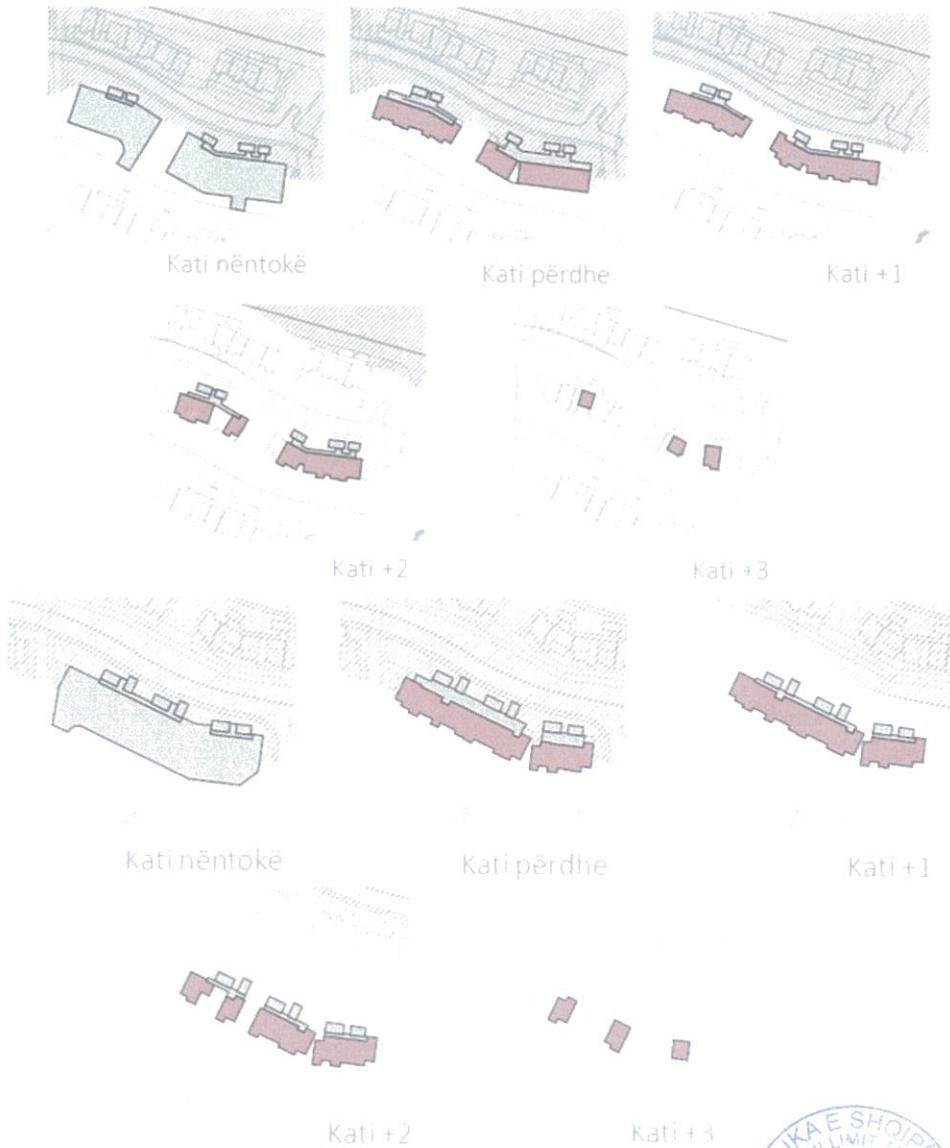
ZONA E1- Zonë me përdorim apartamente
